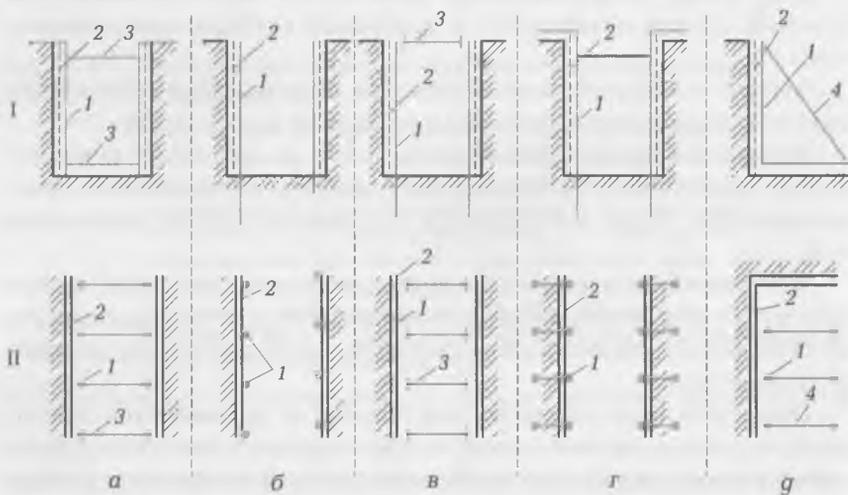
Схемы крепления вертикальных стенок выемок:
